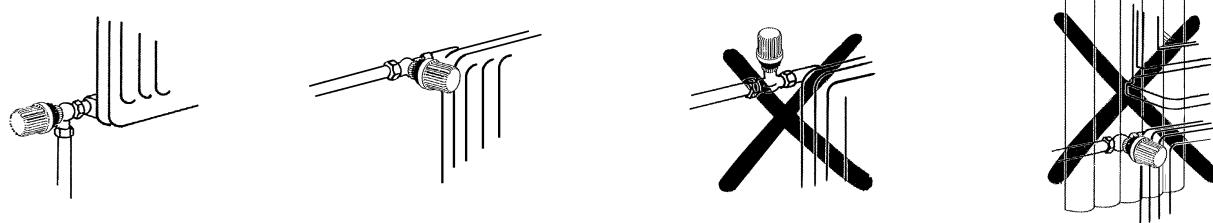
Richtige und falsche Einbauposition für Thermostatregler mit eingebautem Fühler
